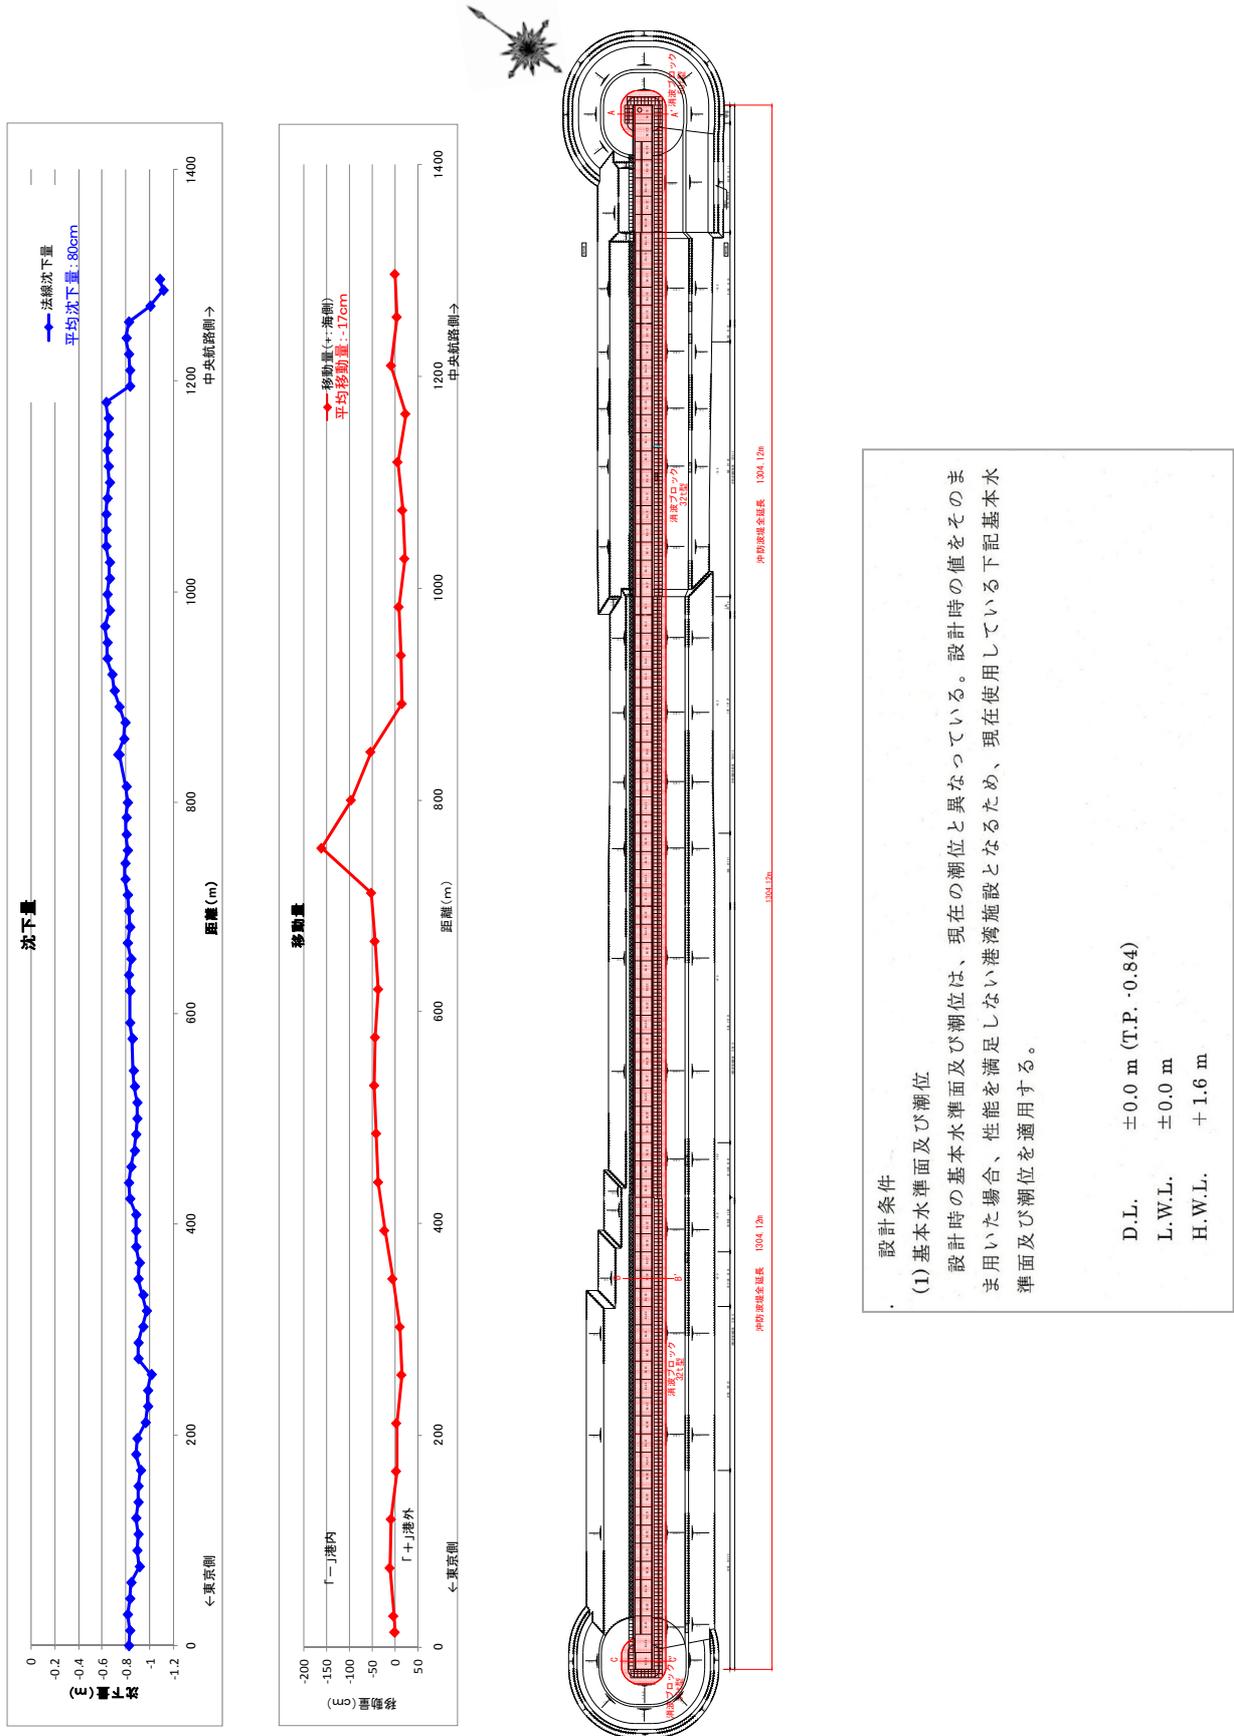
仙台港区\_外港地区\_沖防波堤の平面図, 沈下・移動量 (被災後)
